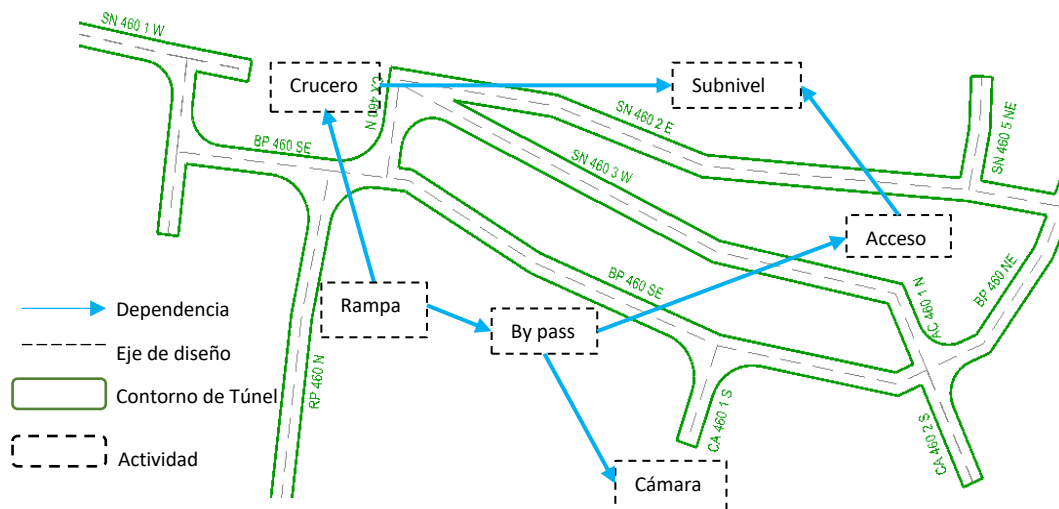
Plan de producción 2018 - Dependencias entre túneles según campo tipo de labor en plano por subnivel.
